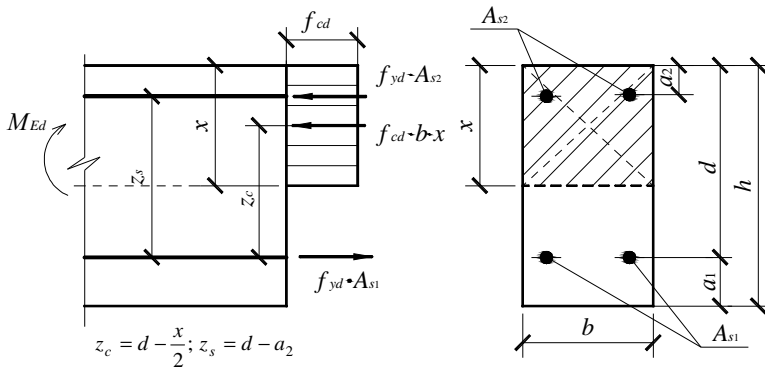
Розрахункова схема нормального перерізу прямокутного профілю з подвійною арматурою
